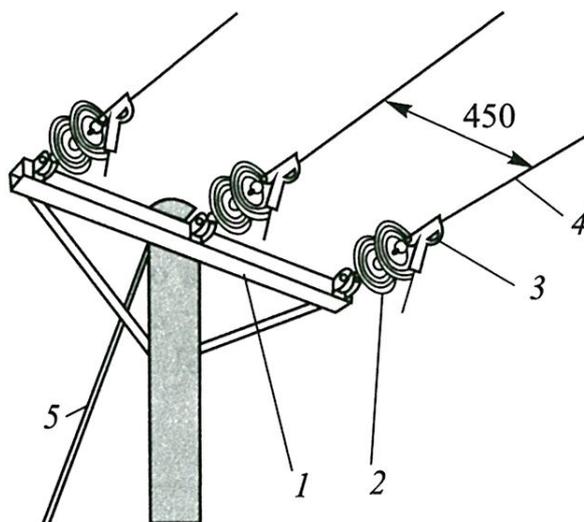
Схема концевой опоры с натяжными изоляторами: 1 — траверса; 2 — тарельчатый изолятор; 3 — натяжной зажим SO 85; 4 — провод SAX; 5 — оттяжка
